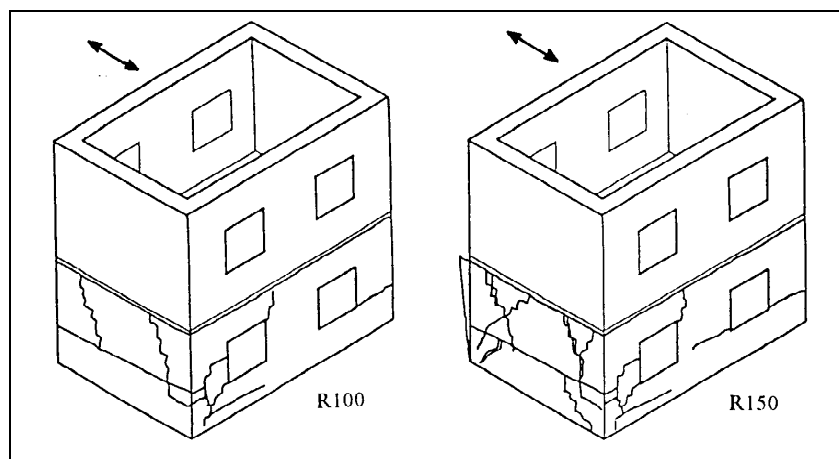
Fissuration des murs d'un prototype testé sur une table vibrante pour deux niveaux de sollicitations différents
